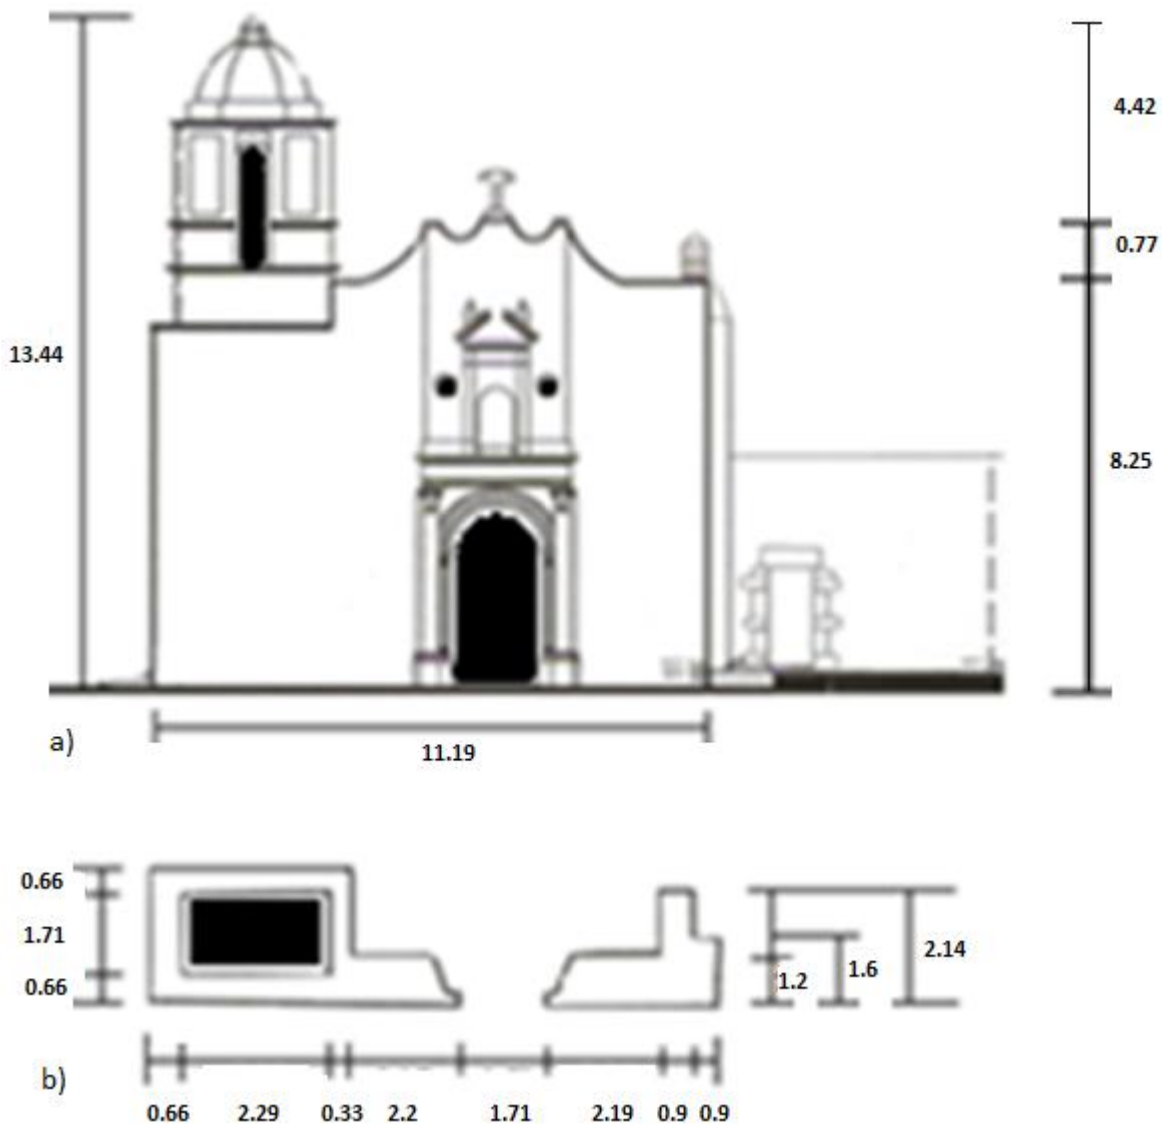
Geometría de la fachada de la Parroquia de Santa María Nativitas (dimensiones en m)
